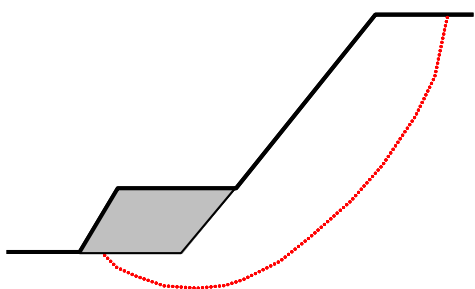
Esempio schematico di stabilizzazione di un corpo di frana (in rosso la superficie di scivolamento) tramite appesantimento al piede: la linea marcata rappresenta il profilo finale del versante, l'area in grigio la massa di riporto -
